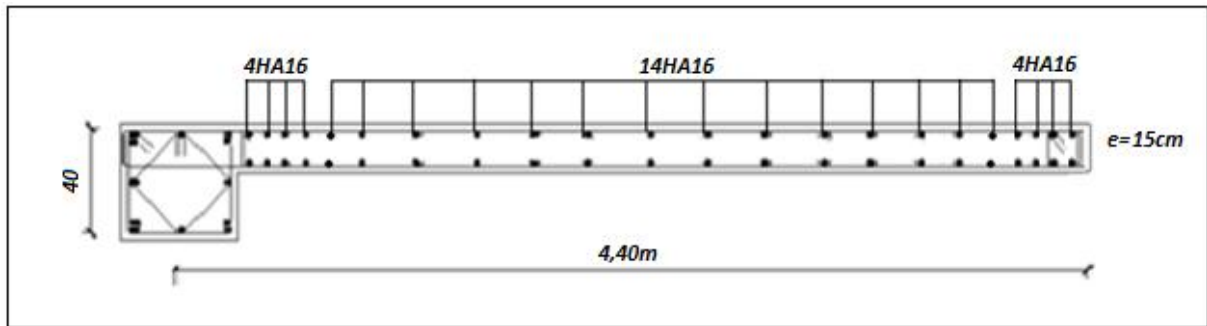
Schéma de ferrailage longitudinal de l'ensemble Poteau (RDC) et voile V1.
